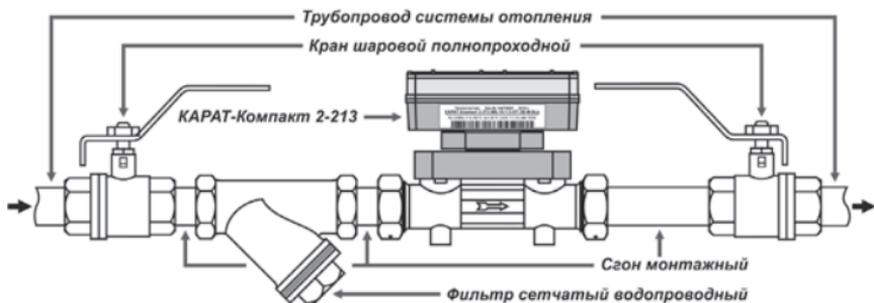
Пример монтажа теплосчетчика в трубопровод
